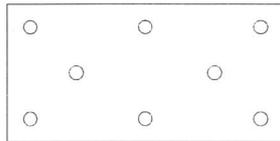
Plans de chevillage – panneaux de dimensions 1000 x 500 mm
